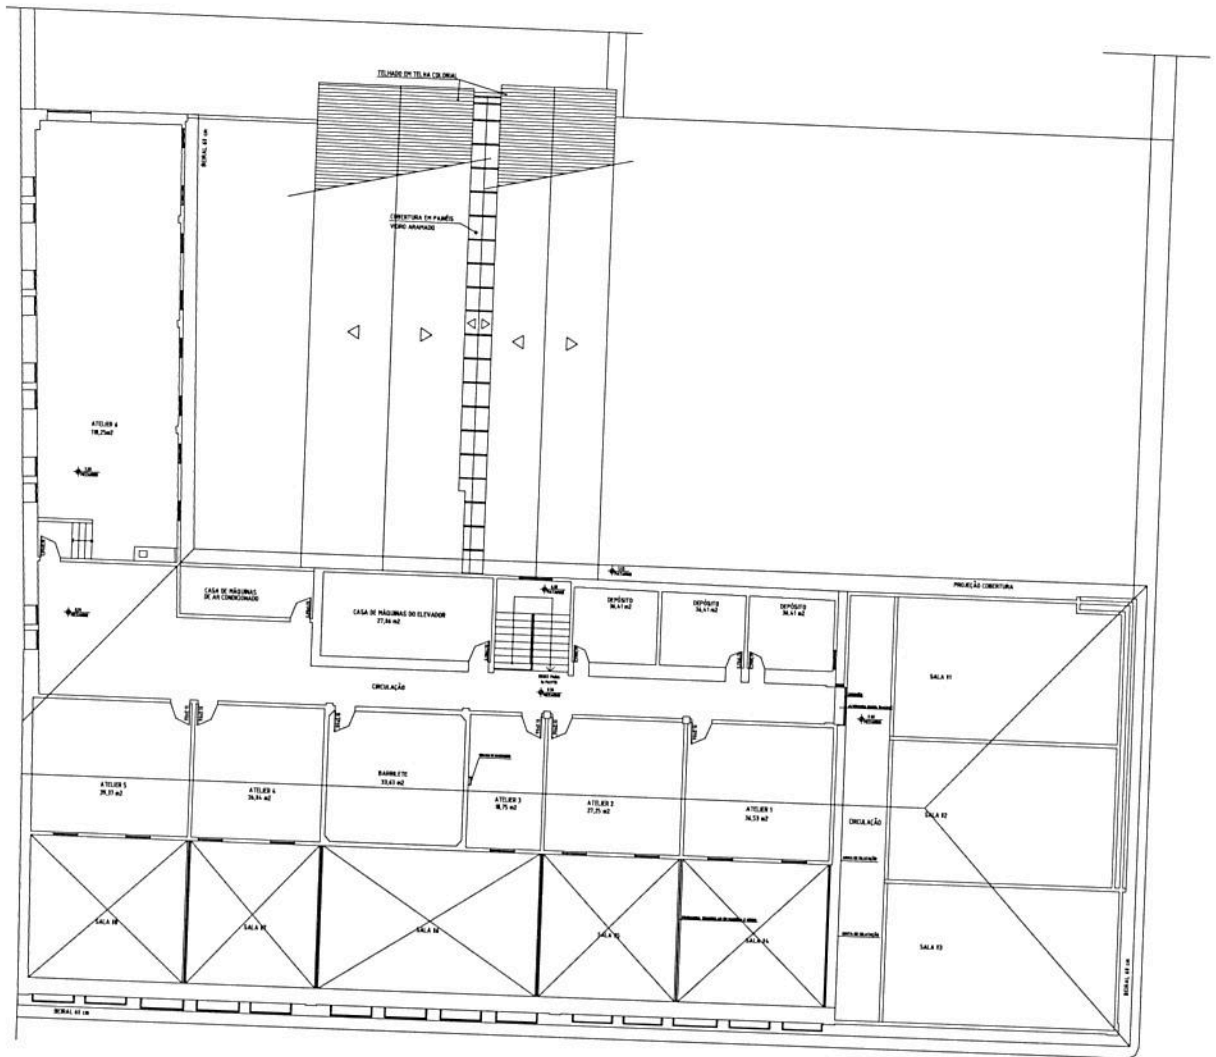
Planta Baixa – Mezanino (Sem Escala) RUA DA ESTRELA
